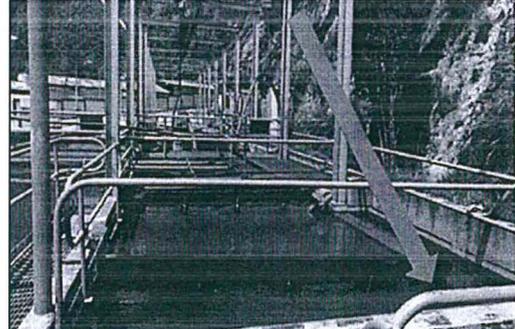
VISTA COMPLETA DE PLANTA DE TRAMIENTO DE AGUAS
